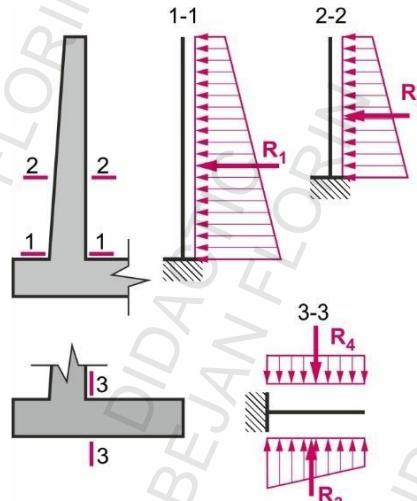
Schemele statice pentru determinarea momentelor încovoietoare și a forțelor tăietoare
